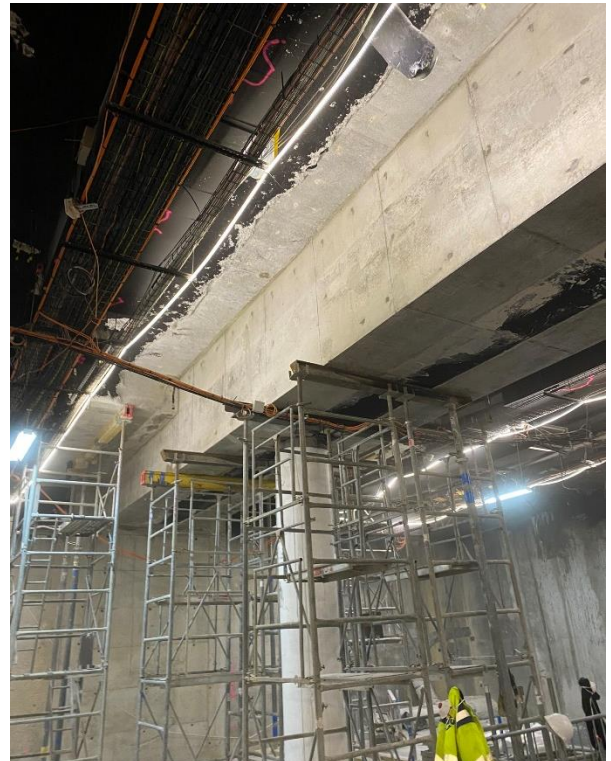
Vigas listas para la puesta en carga antes de la demolición del pilar.
